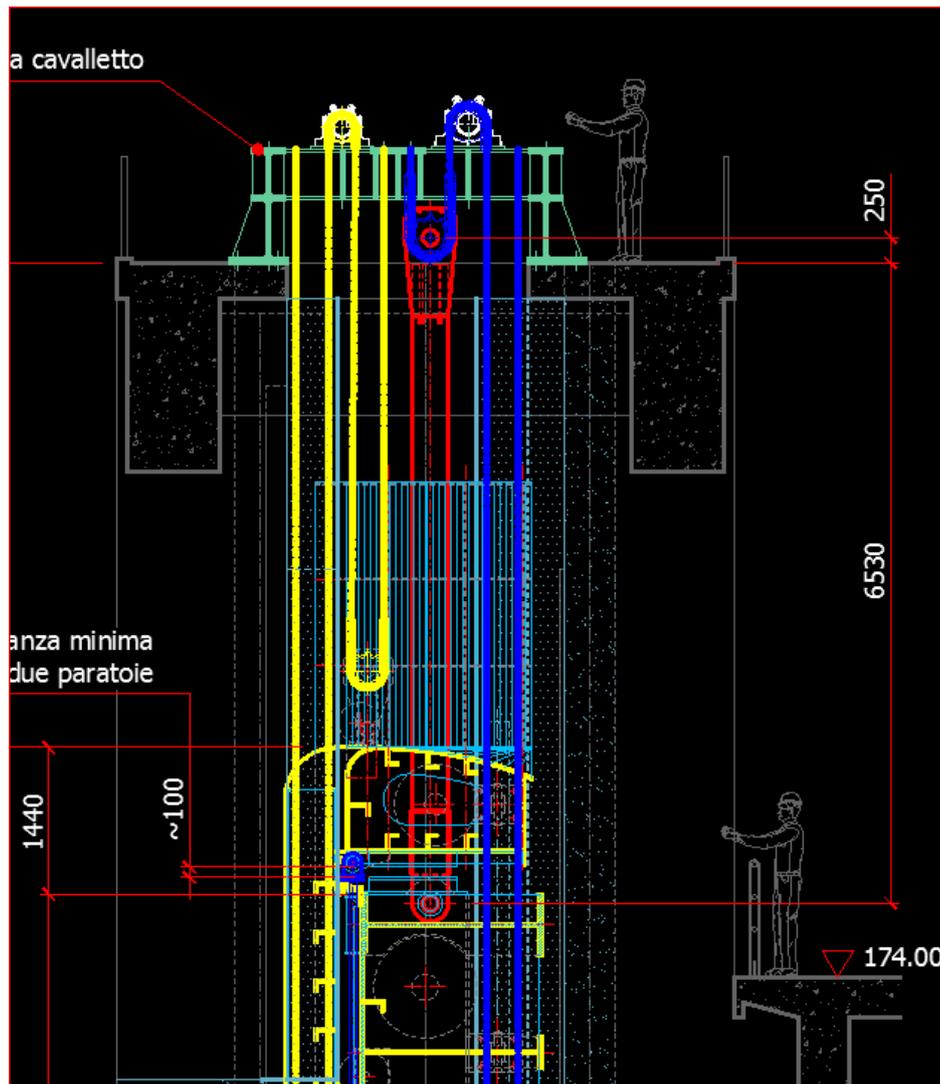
sezione nuovi gruppi di sollevamento (inferiore: blu – superiore: giallo)
